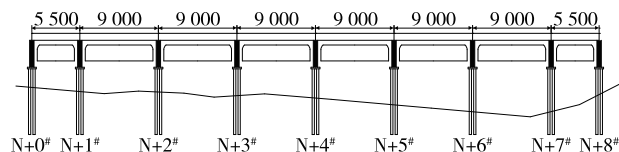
镇罗黄河特大桥主桥桥型布置示意图(单位: cm)
